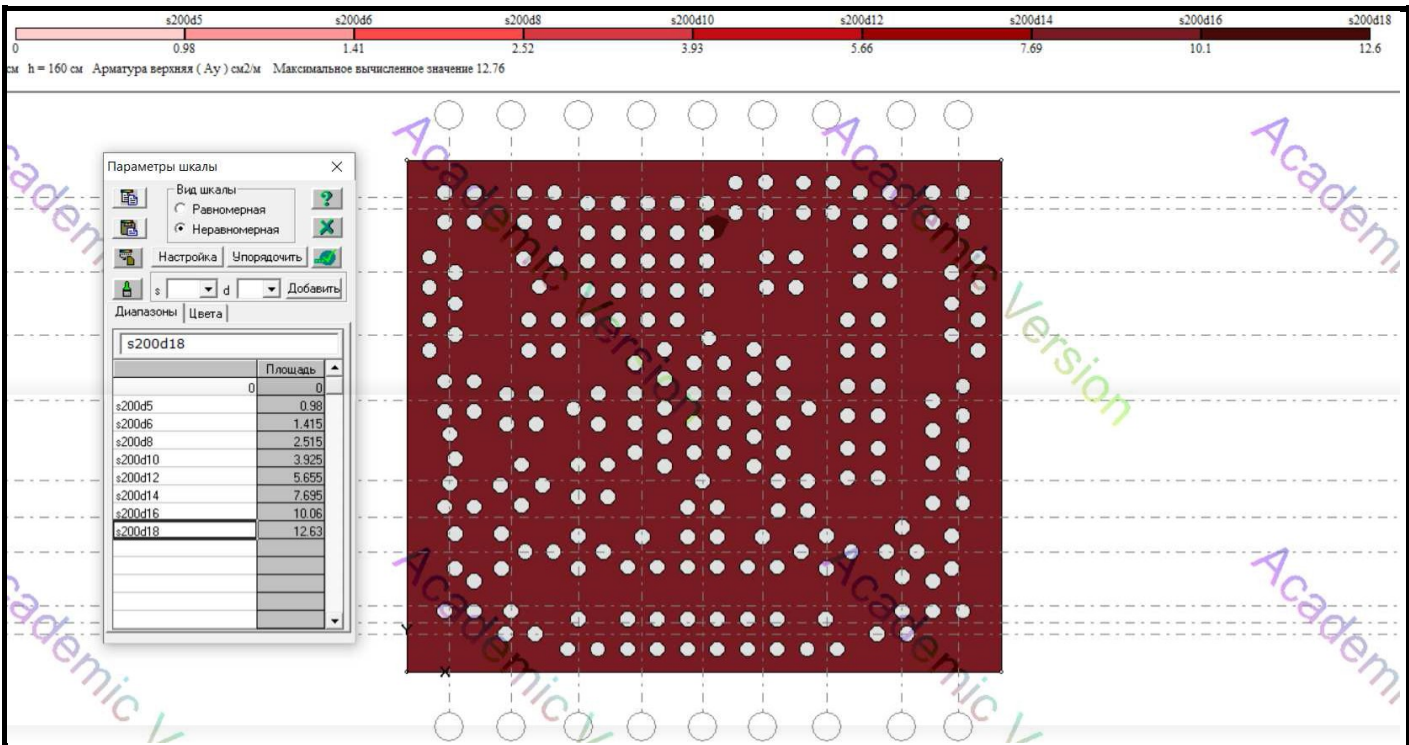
Арматування зони верхньої фундаментної плити каркасно-монолітного багатоповерхового будинку вздовж осі Y
